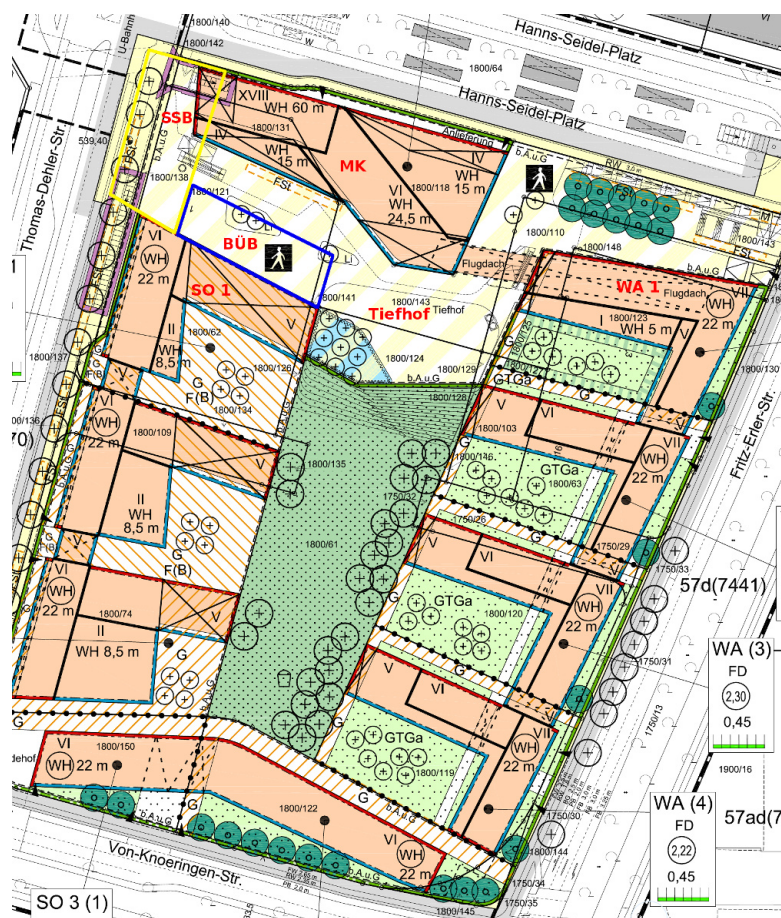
Übersicht Bebauungsplan Nr. 1609
